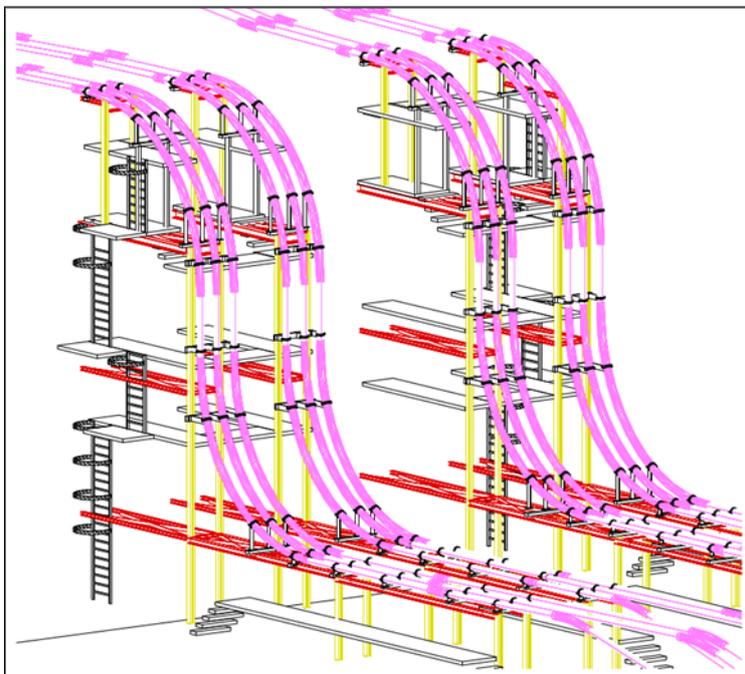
Stahltragkonstruktion, exemplarisch für die Schachtbauwerke
